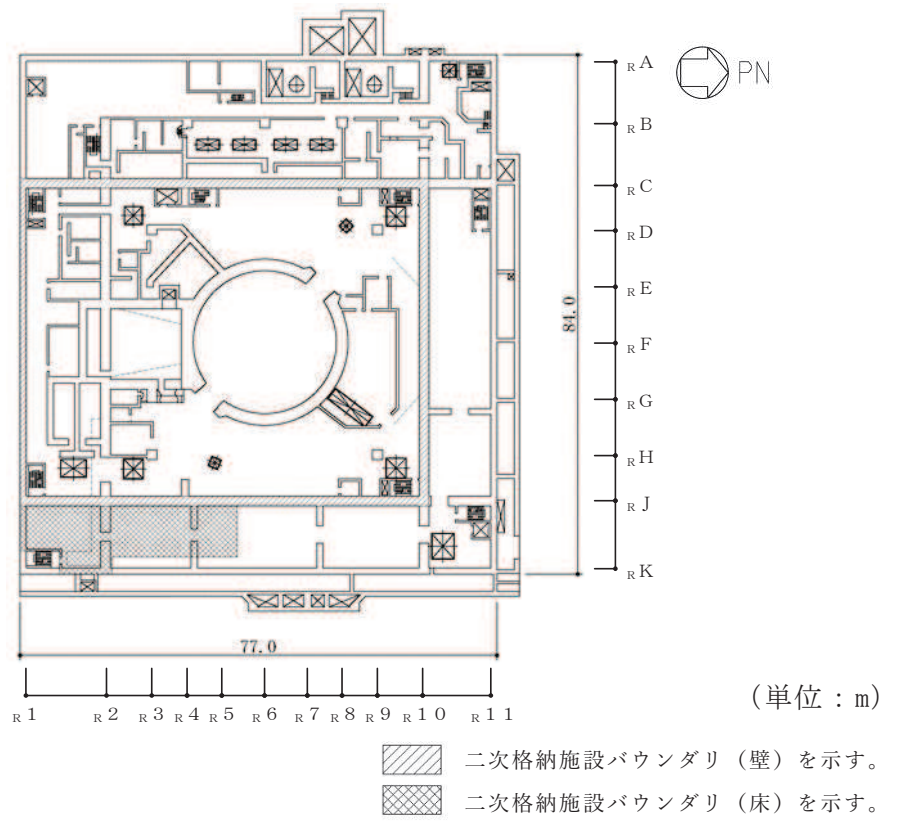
原子炉建屋原子炉棟（二次格納施設）の範囲の平面図
